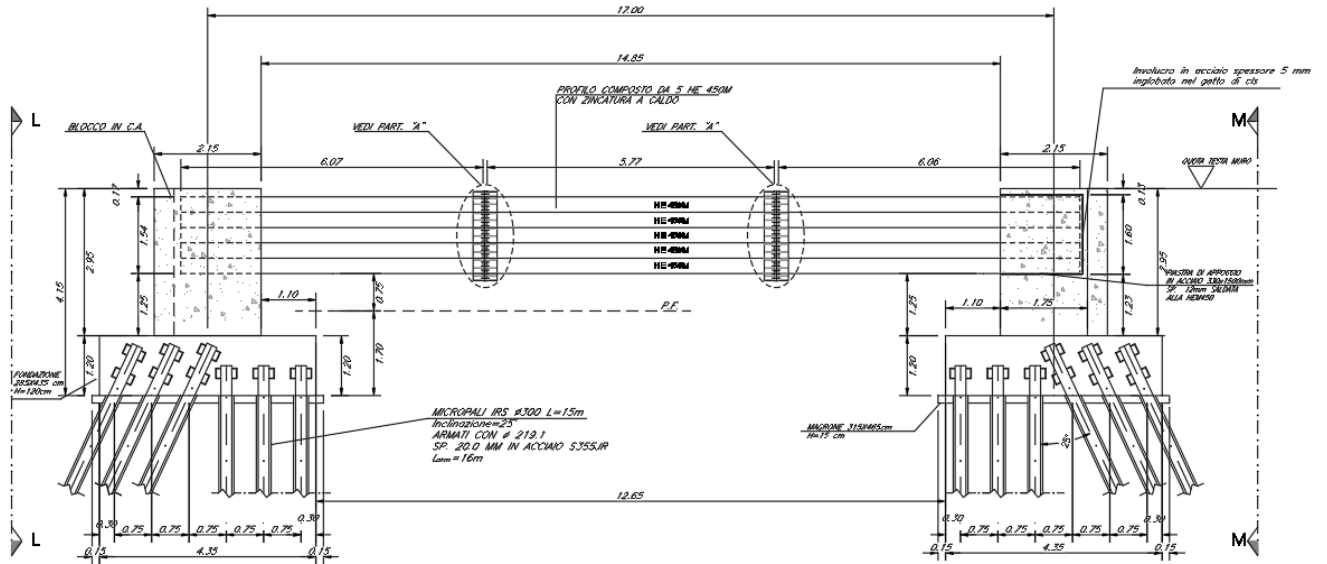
MU03 - prospetto generale muro opera di protezione con luce asse-asse di 17.00 m.
